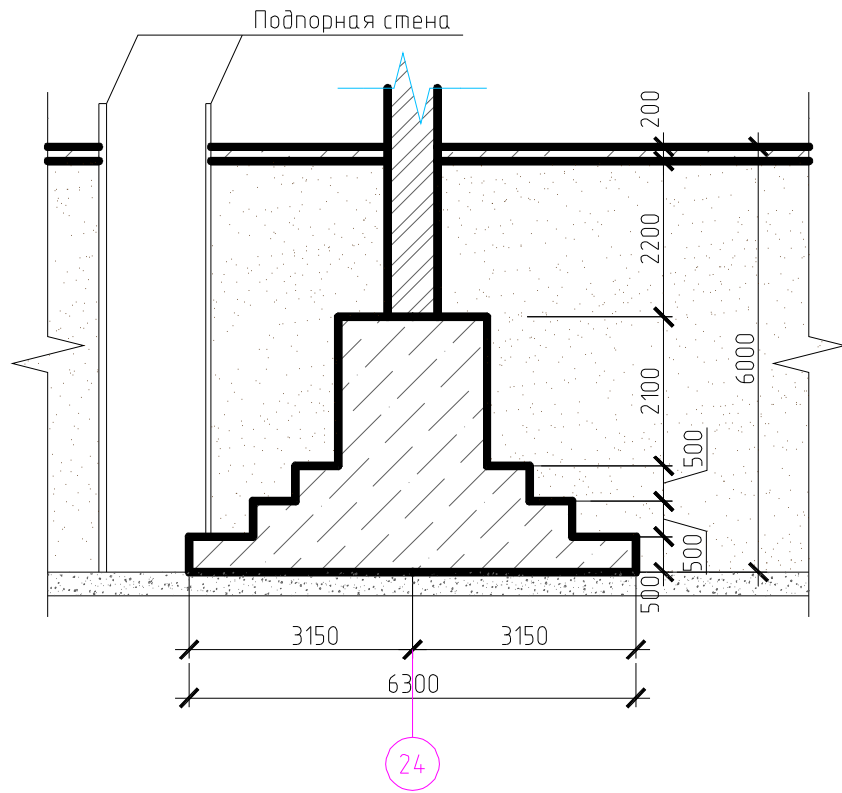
Схема фундамента в осях «24/Е»
